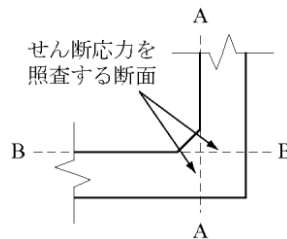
せん断力に対する照査位置（フルーム形状）
